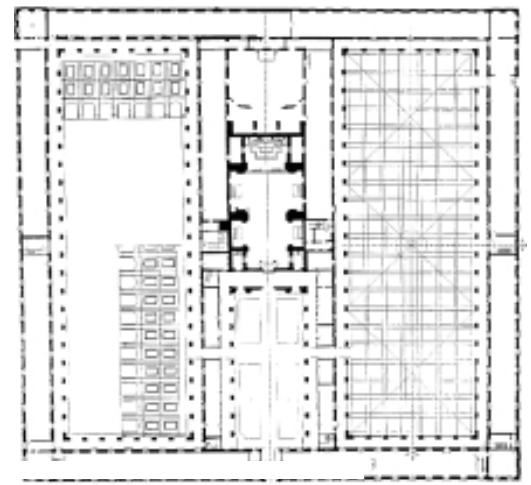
Planta hogar Pignatelli, Gregorio Sevilla, 1778
